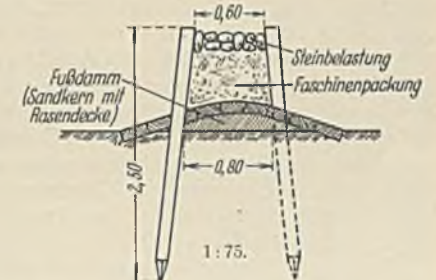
Querschnitt einer schweren Buschlahnung.
